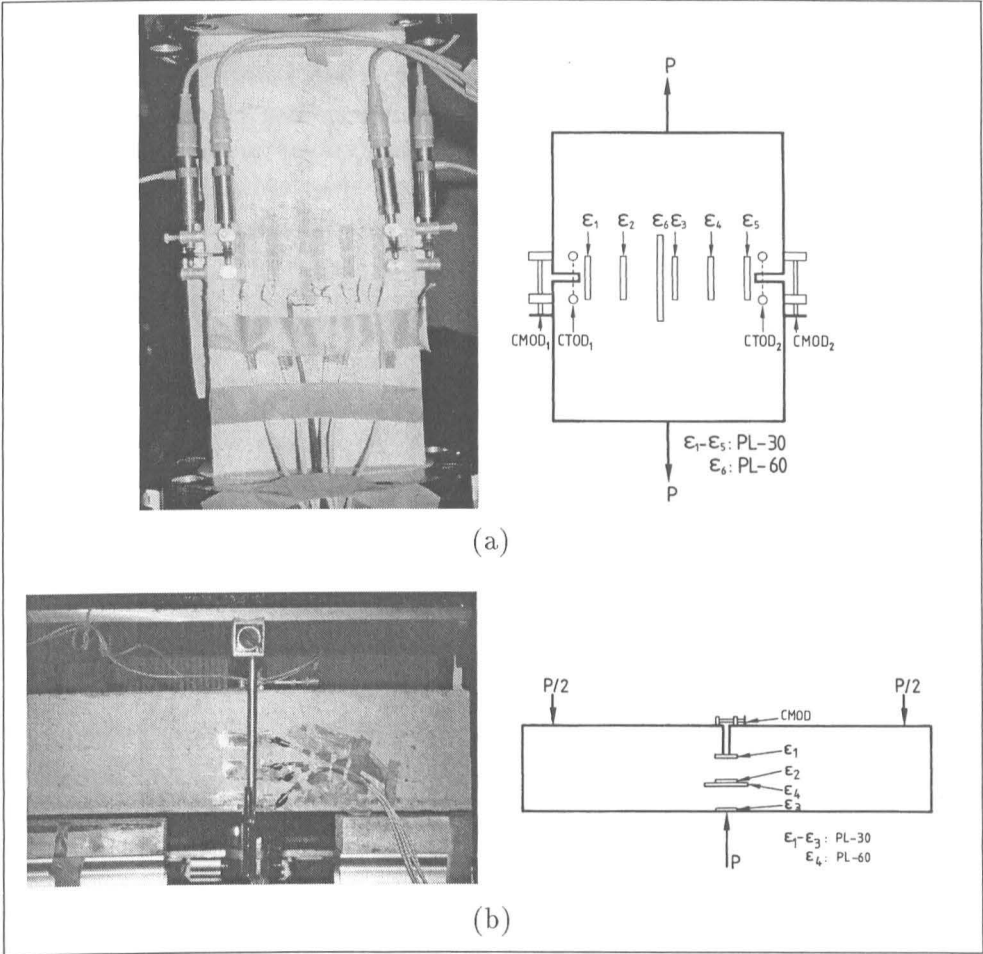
Instrumentierung der Probekörper: (a) Anordnung der Meßtechnik am Kerbzugkörper. An den Kerben sind zur Regelung und zur CMOD-Messung induktive Wegaufnehmer angebracht. An den Seiten befindet sich je ein Wegaufnehmer, der zur Messung der Zugexzentrizität dient. (b) Anordnung der Meßtechnik am Biegebalken. Der zur Messung der Durchbiegung erforderliche Wegaufnehmer ist auf dem oberen Bild zu sehen: die zwei Aufnehmer zur Messung der Rißöffnung und die vier angeordneten DMS am CTOD, in der neutralen Faser (bei Versuchsbeginn) sowie am Zuggurt.
